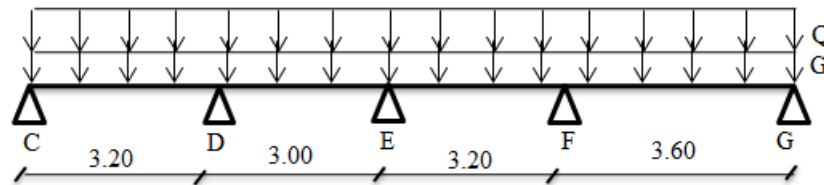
Schéma statique du poutrelle type 01 -terrasse inaccessible-
